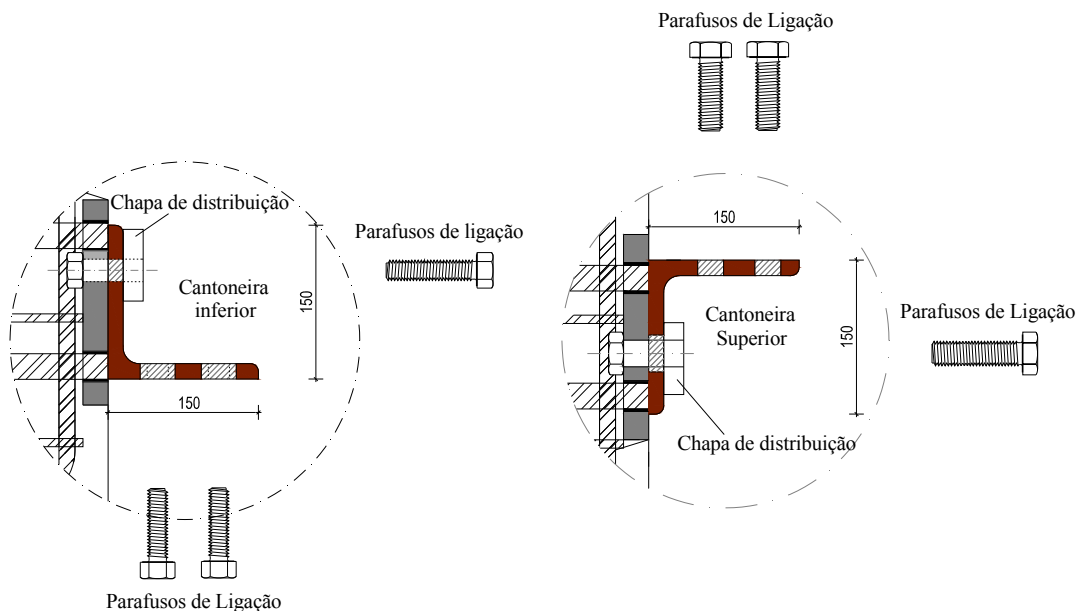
Pormenor da ligação inferior e superior das cantoneiras ao pilar
